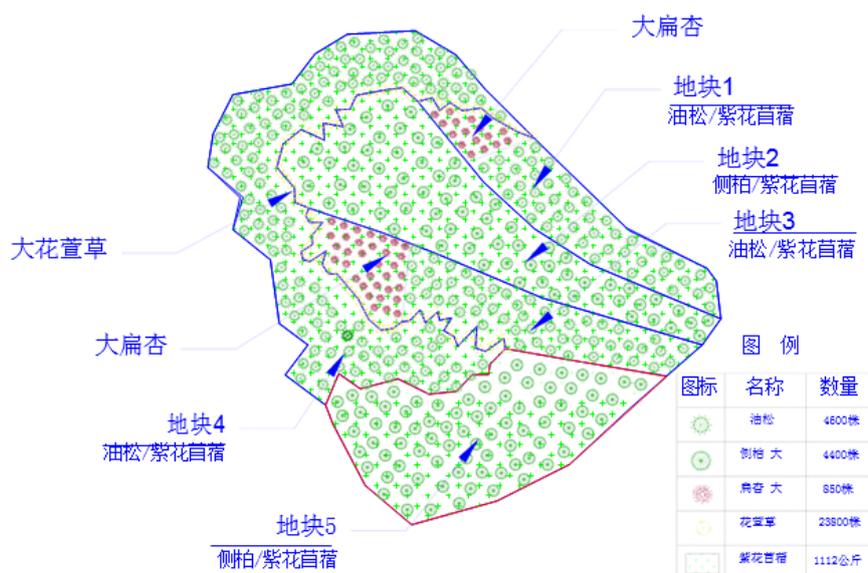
南一盘区综合整治示范工程平面布置图
